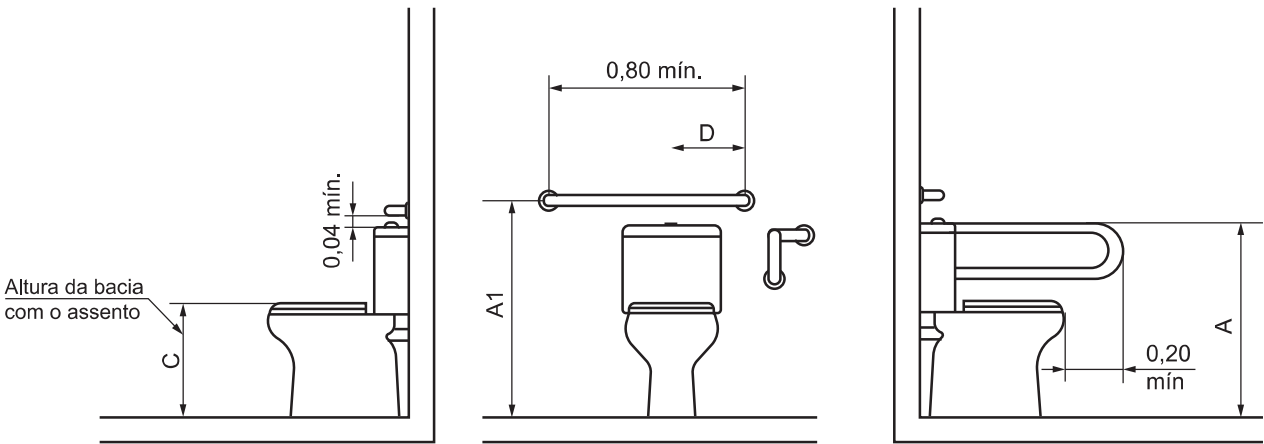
Sem parede lateral – Bacia convencional ou suspensa com barras de apoio reta e lateral fixa – Exemplo A
